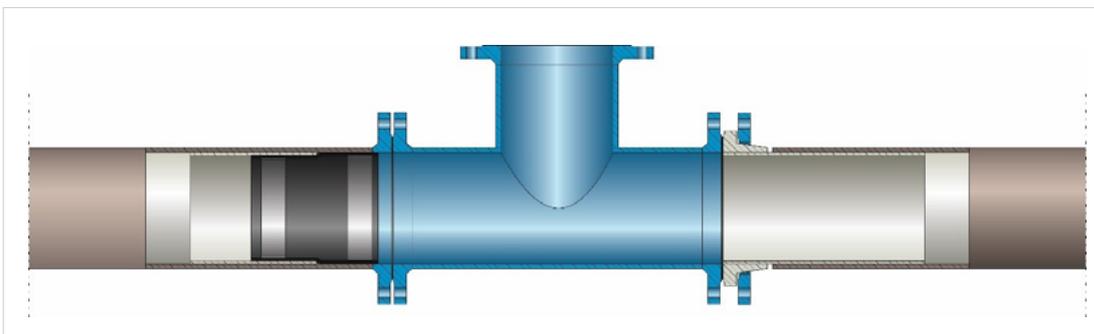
Beispiel zur Herstellung von Anschlüssen am Druckschlauchliner (links – Verbindung über das Altrohr mit Vorschweißflansch und LEM, rechts – Verbindung über den Druckschlauchliner mit GFK Flansch)
